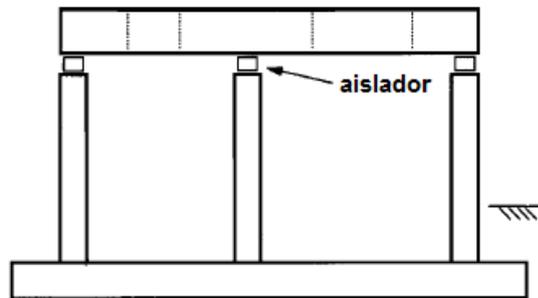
Cimentación tipo pórtico (mesa) con aisladores. Fuente: ACI
